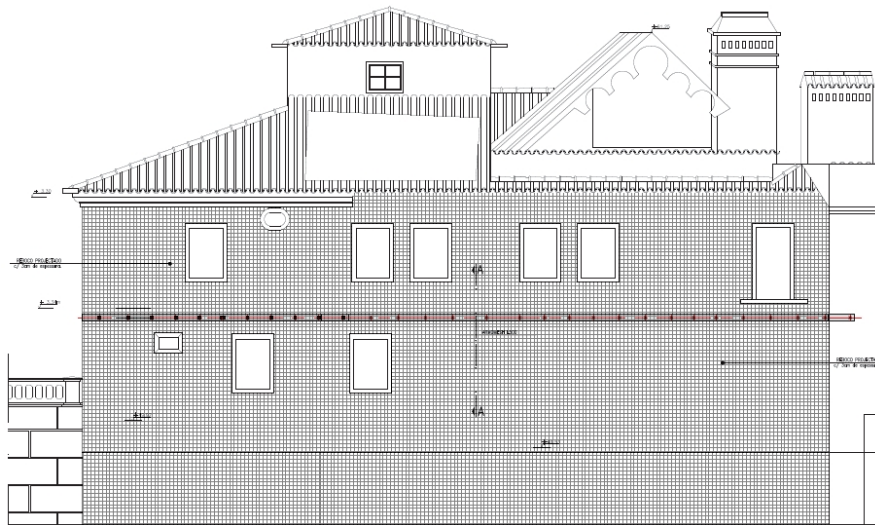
Aplicação de reboco armado na fachada poente [30]
